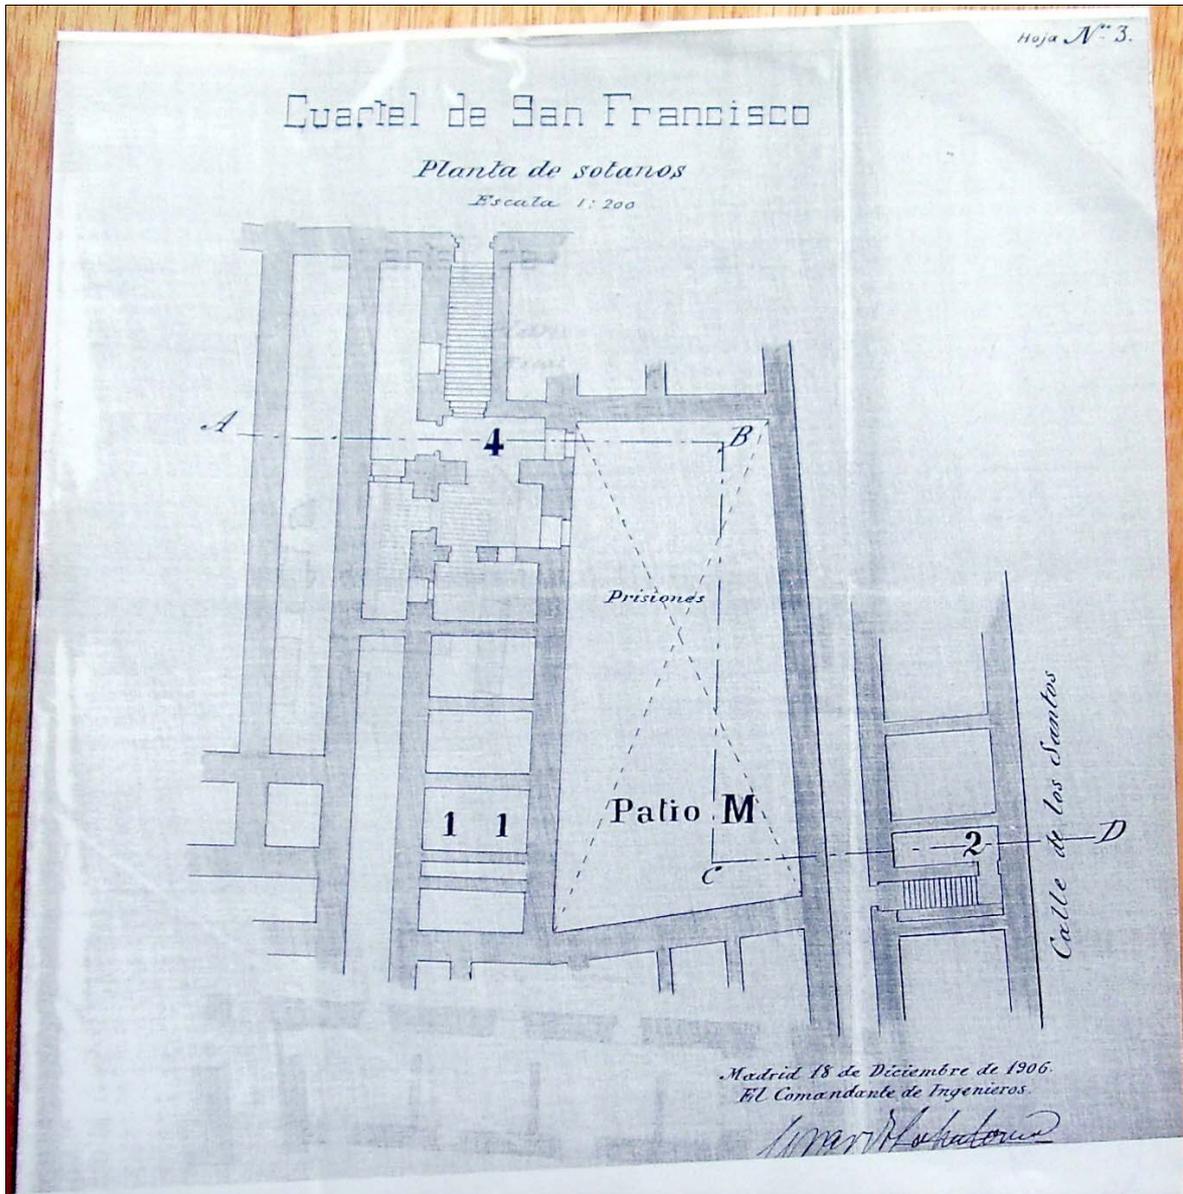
Cuartel de San Francisco. Levantamiento planimétrico del nivel de sótanos de la zona de Prisiones Militares. Escala original, 1:200. Archivo General Militar, Sección 3ª., división 3ª., leg. 580.
